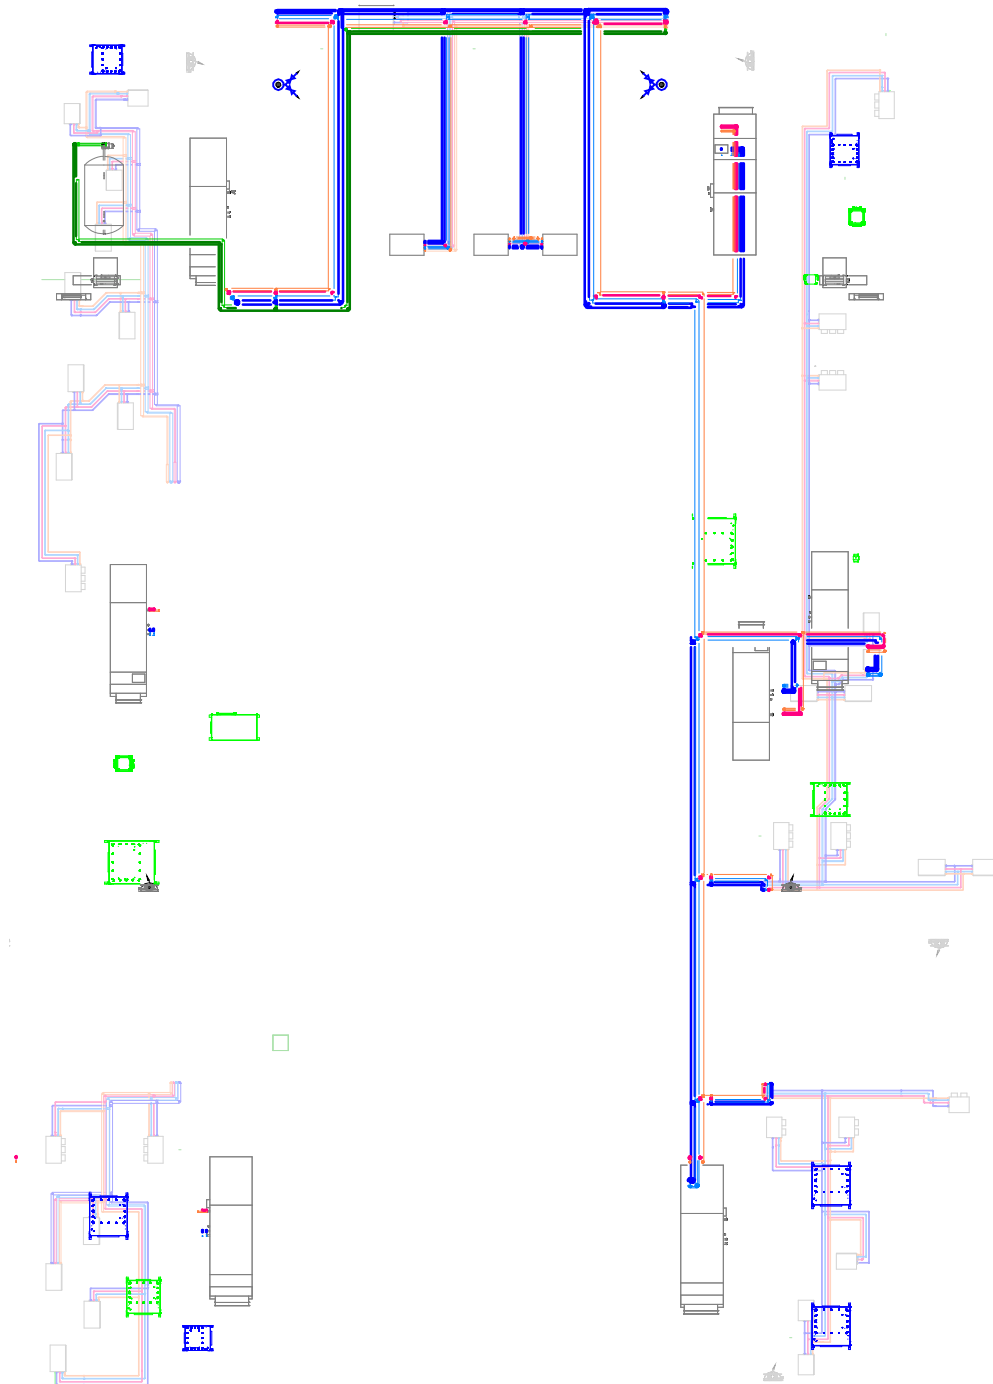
Planta do traçado das tubagens de água na *mezzanine* à escala 1:250.
